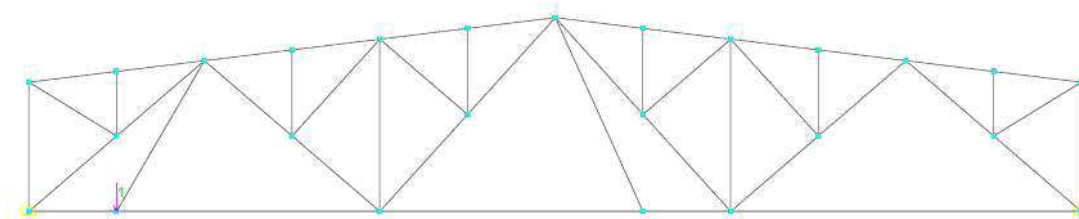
Схема загрузки фермы от крановой нагрузки (кран слева)
